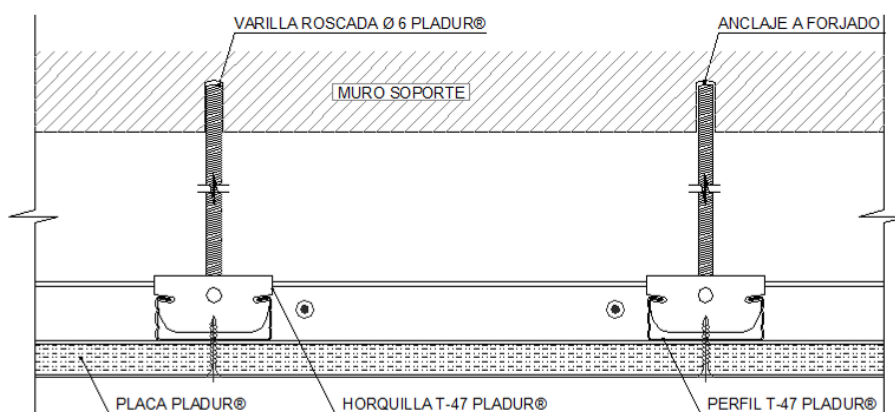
Pormenor tipo do tecto falso em gesso cartonado [Pladur®, 2020]
